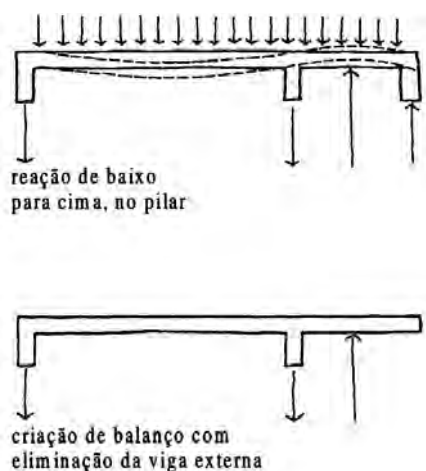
Diagrama estrutural comparativo entre soluções de laje com viga externa e sem viga (plano em balanço). [REBELLO, 2000]:196
